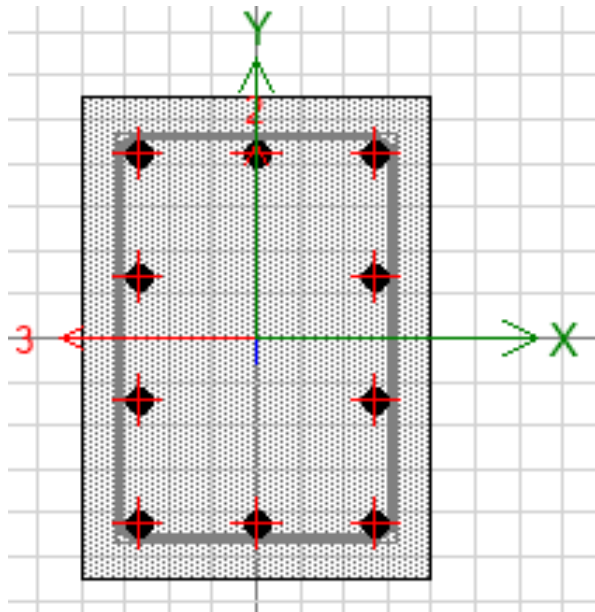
Columna 40x55cm en Section Designer de ETABS. Fuente: Propio.
